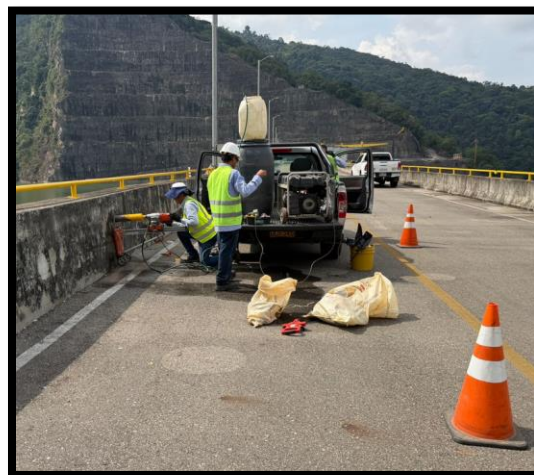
Ubicación muestreo Muro Parapeto de la Presa – Fuente Empresa del Sector Eléctrico Colombiano.
